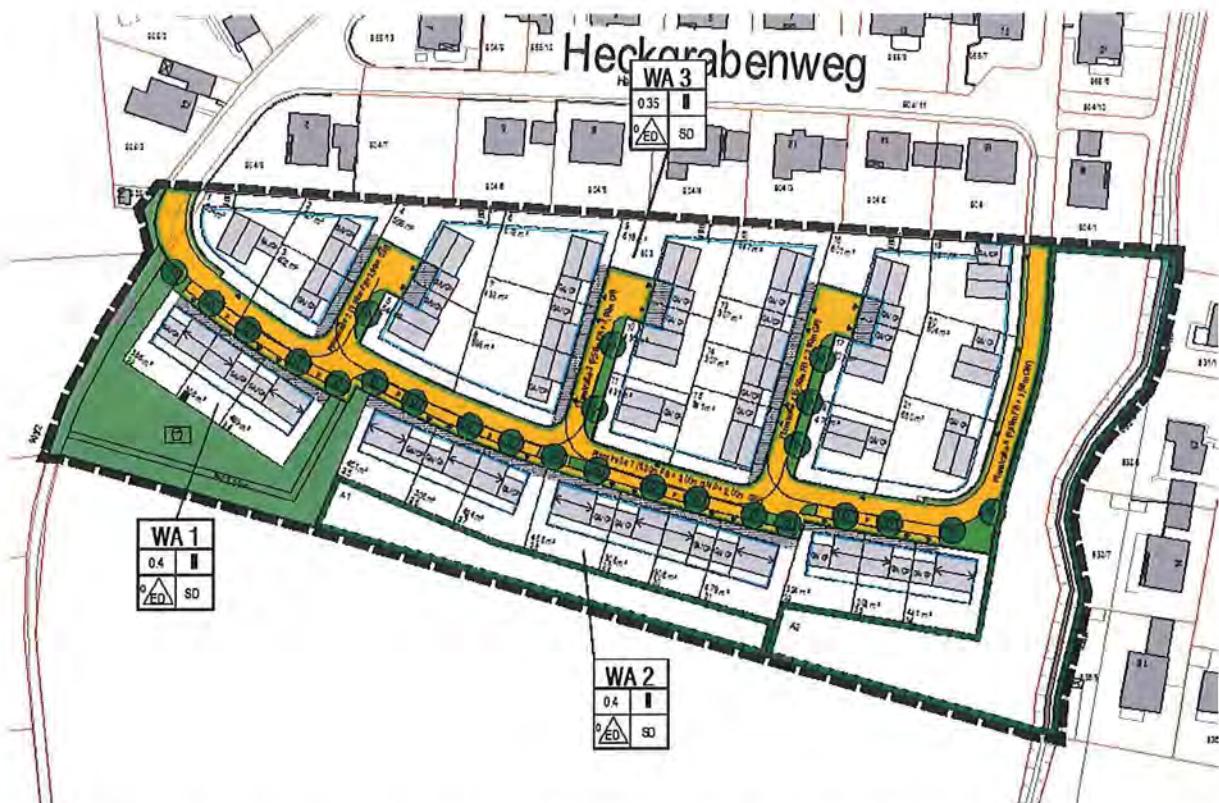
Bebauungsplangebiet mit Darstellung der geplanten Bebauung
